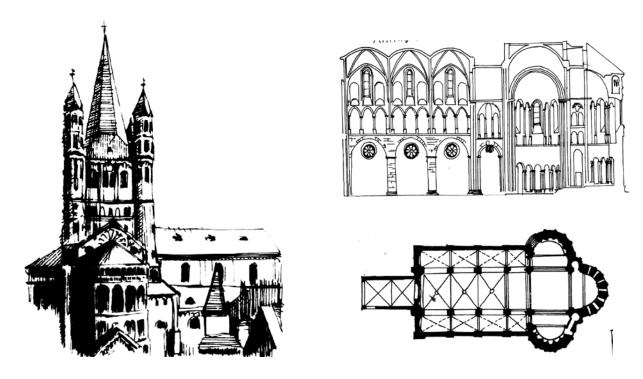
Кёльн. Церковь Большого Мартина (1185–1240). Фасад. Разрез. План
